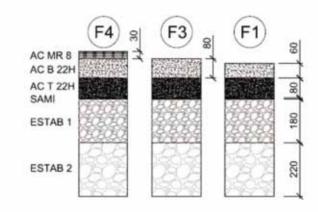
Estructuras del pavimento en los campos F1, F3 y F4.
